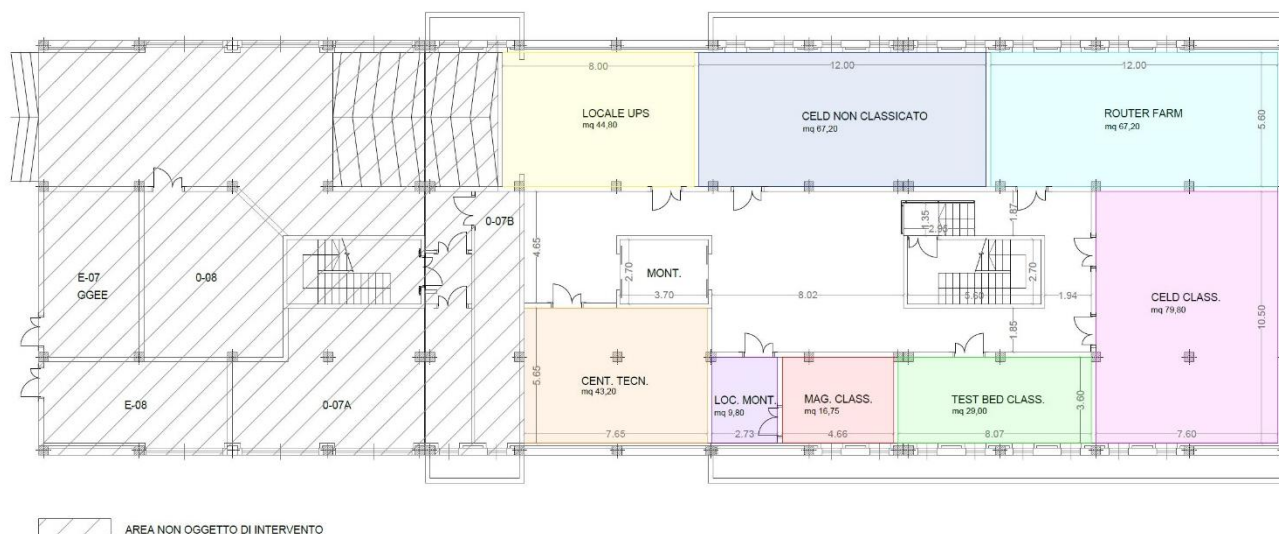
Opzione1- Layout dello stato di progetto nella soluzione con un unico accesso.
